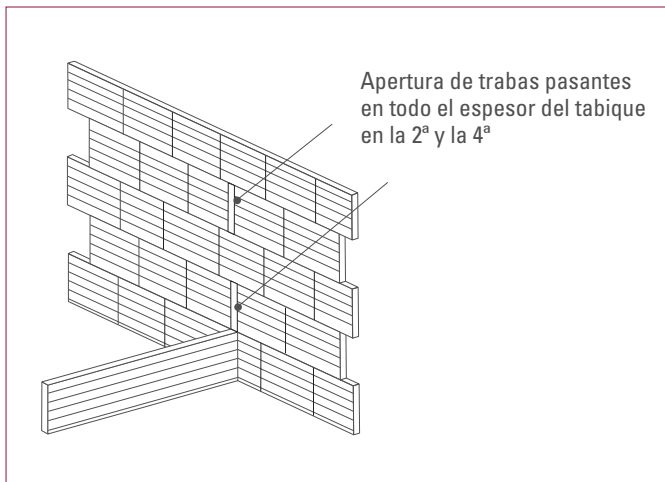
Encuentro perpendicular de tabiques SUPERENVÀ.
